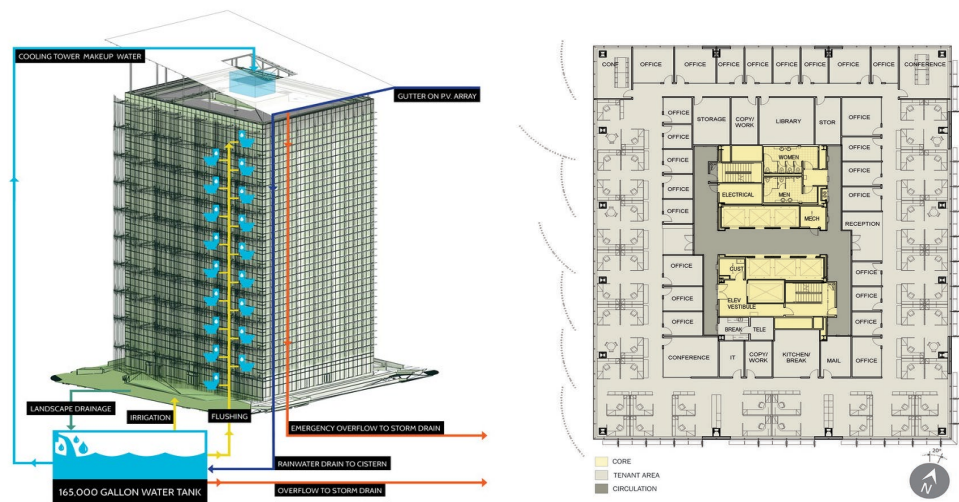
б) Portland Federal Building, Портленд, штат Орегон, США схематичний розріз та загальний вигляд плану у структурі навколишньої забудови
